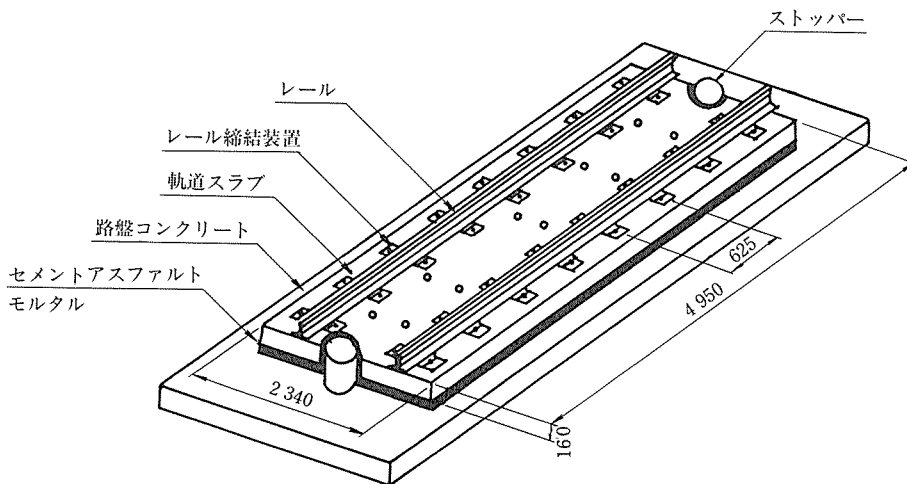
コンクリートスラブ式直結軌道（新幹線用の例）
